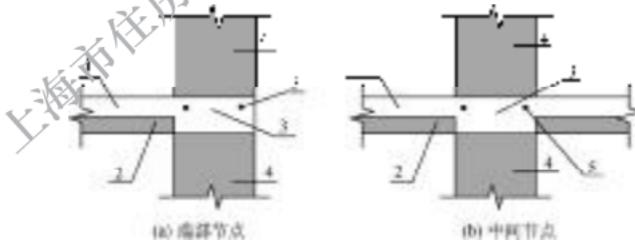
后浇钢筋混凝土圈梁构造示意
